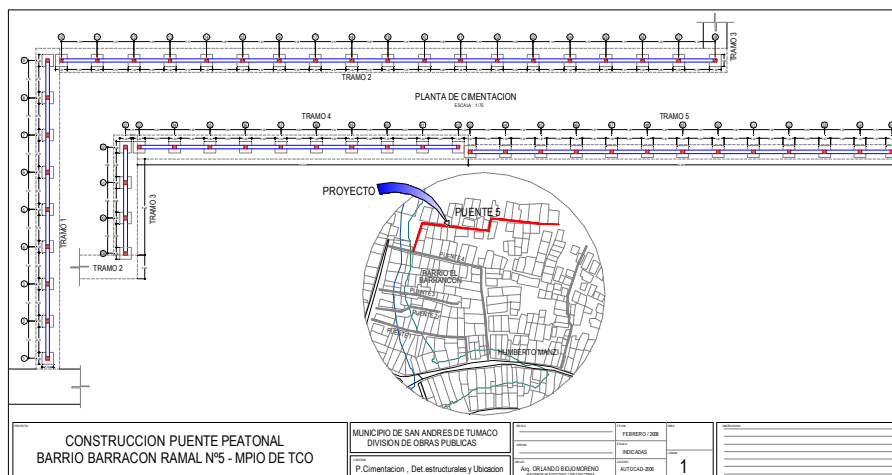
Planta arquitectónica de puente peatonal Barracón, ramal 5, tramos 1, 2, 3, 4 y 5.
